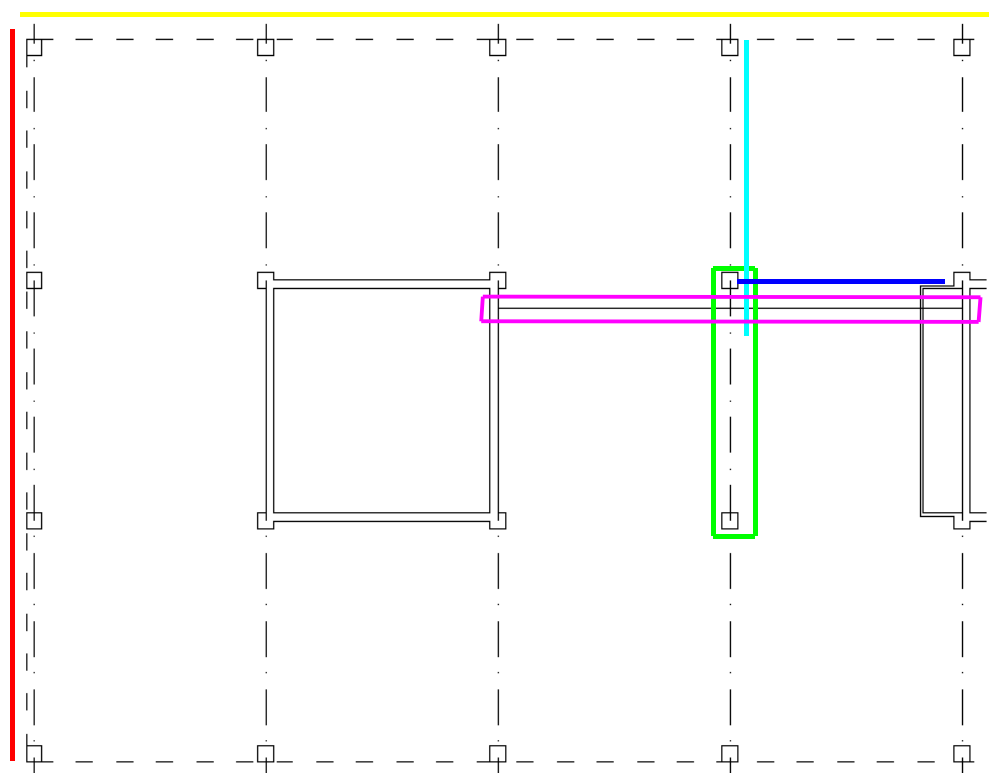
Plànol esquemàtic en planta de la zona del pàrquing. *Font: pròpia (any 2014)
